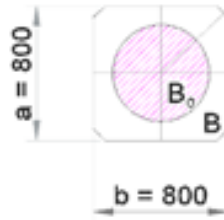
Dimensions en plan d'une cale et de son bossage.
